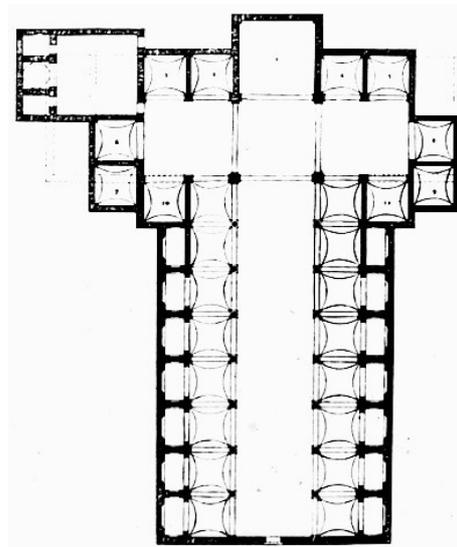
Planta de la Basílica de San Lorenzo, Brunelleschi.
